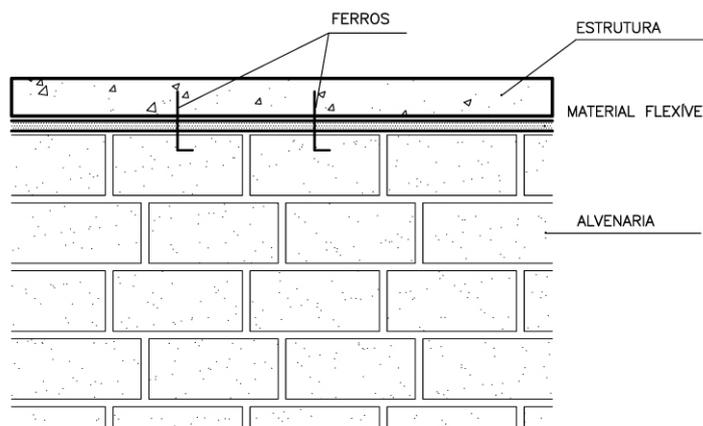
Encontro de alvenaria com laje ou viga deformável
